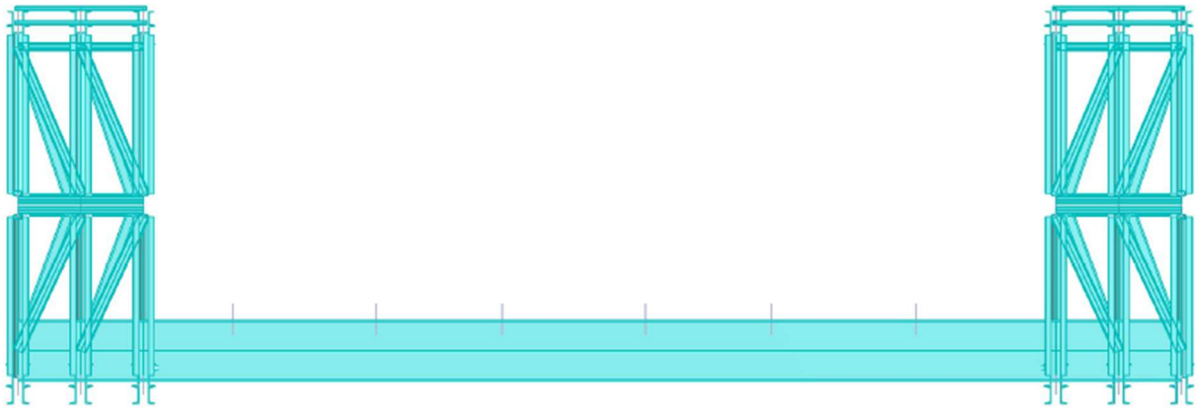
Secção transversal, de ponte com dois níveis de painéis, três planos e três faixas de rodagem
